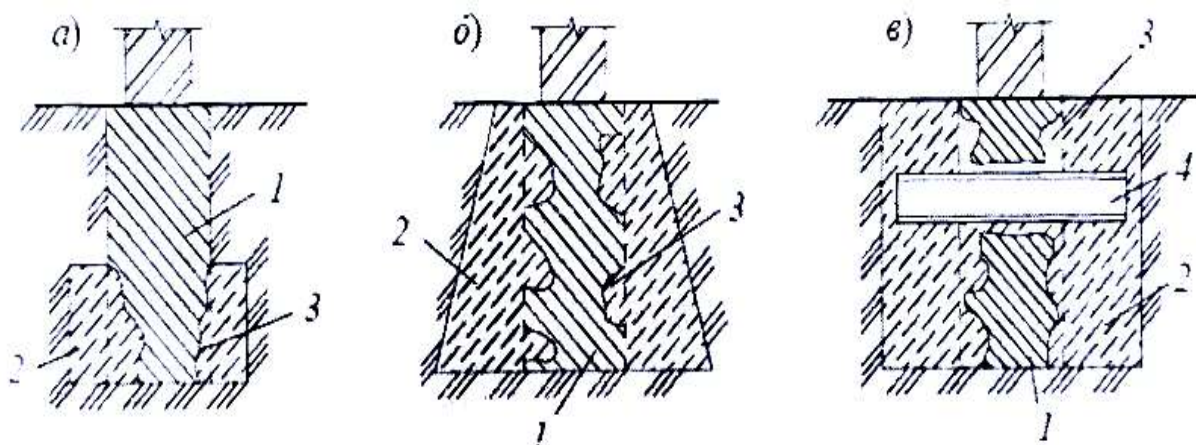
Схемы усиления ленточных фундаментов бетонными обоймами:
